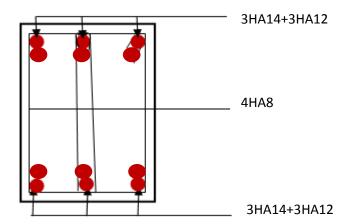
Ferraillage sur appuis d'une poutre secondaire
